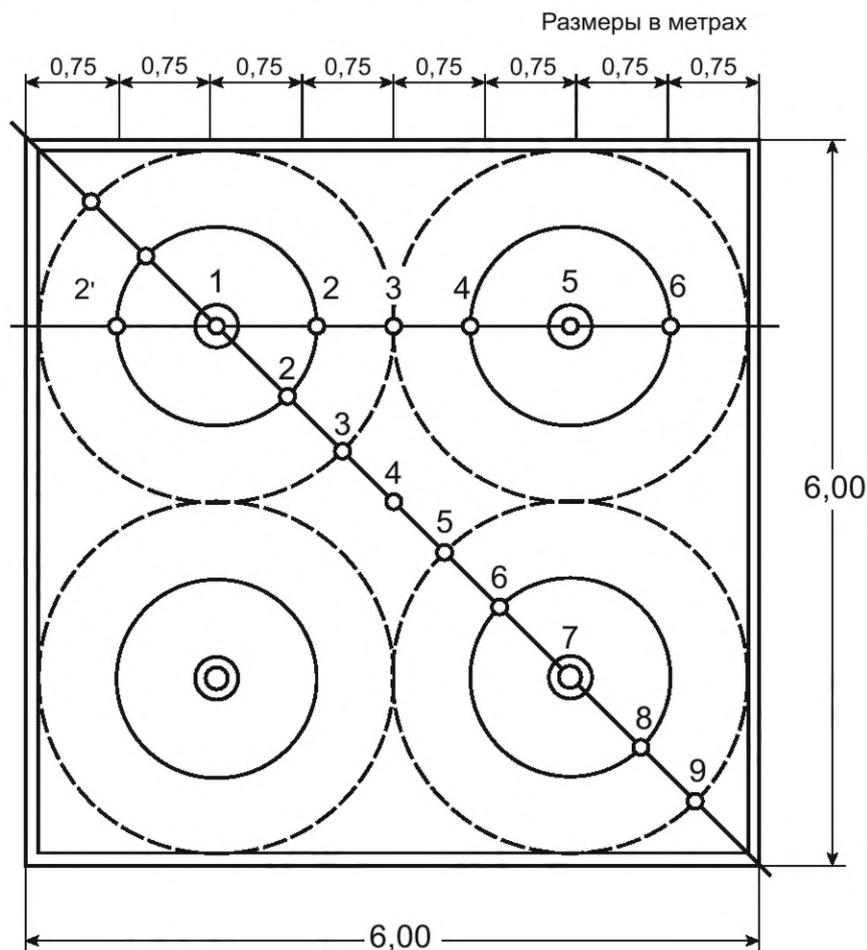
Размещение трубчатых световодов естественного света на плане помещения (с изолиниями КЕО от каждого световода)
